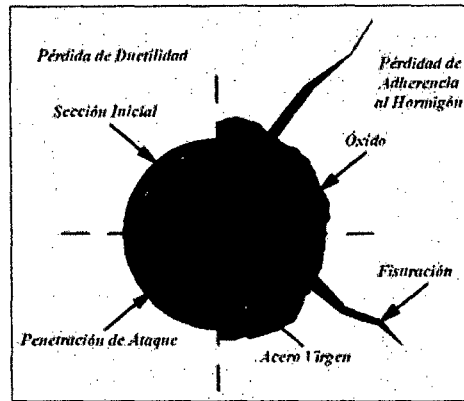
23. Fisuración del concreto, radial a las barras de refuerzo. Fuente: (Stuardo P., 2008)
